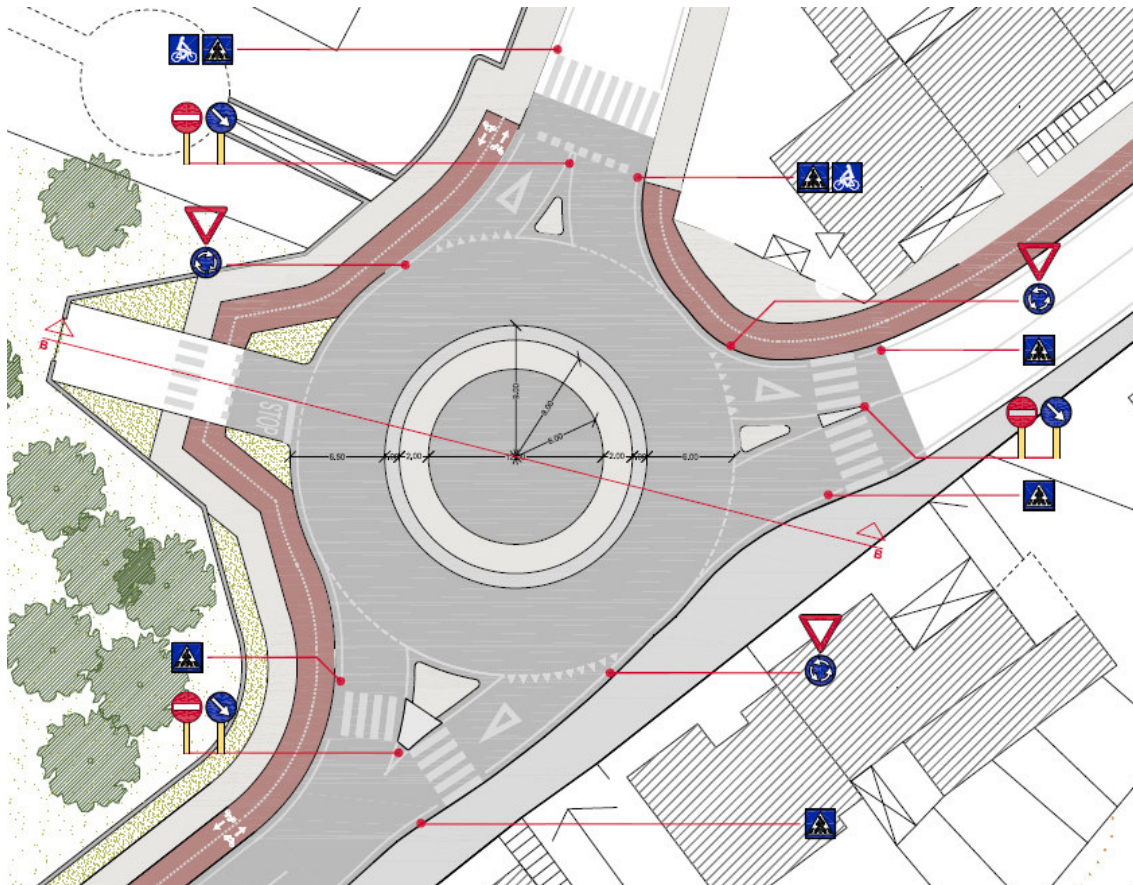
Planimetria di progetto, rotatoria sull'intersezione tra Via Casu e Via Anglona
